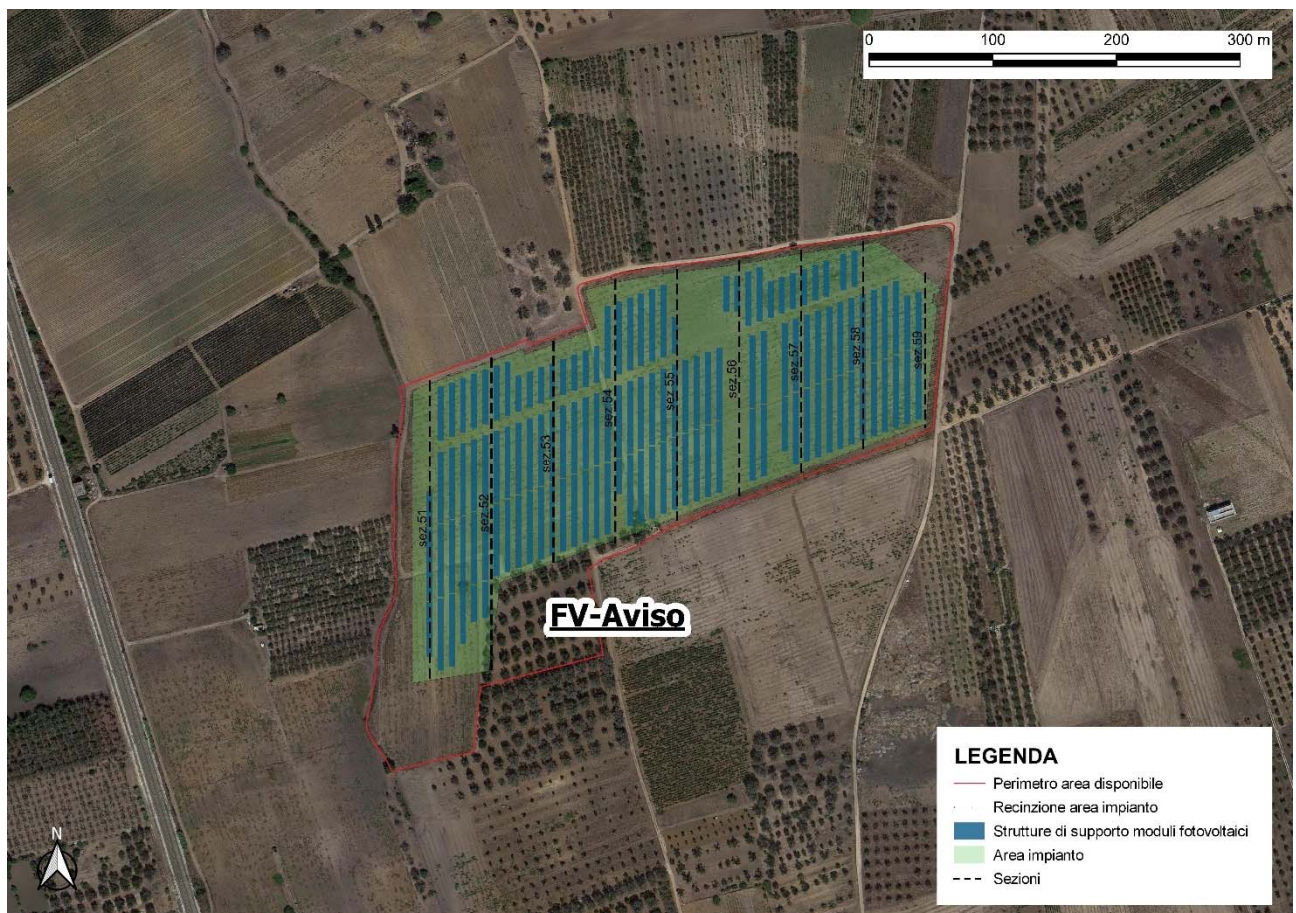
Sezioni sul sito di installazione FV- Aviso
